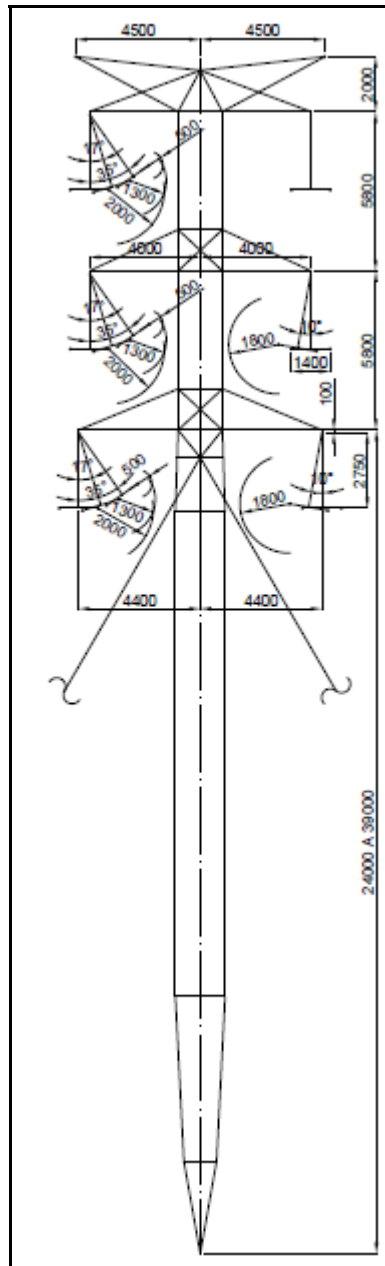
ESTRUTURA TIPO JMEL - Estrutura para Suspensão Estaiada
